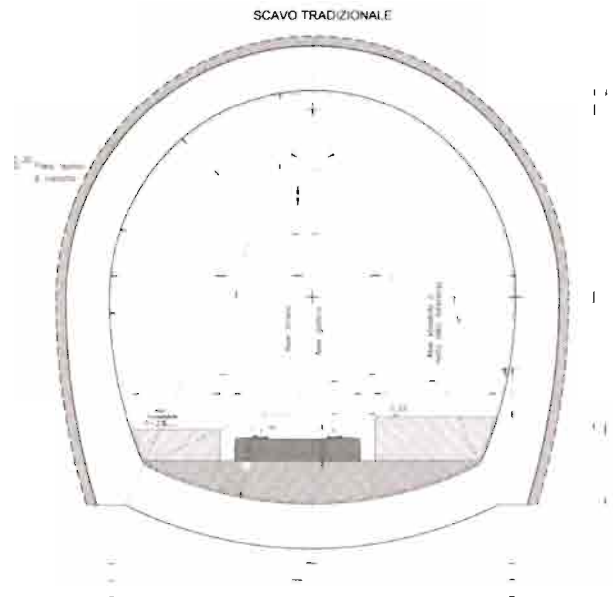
Sezione tipo di intradosso LT galleria a semplice binario. Scavo tradizionale.
